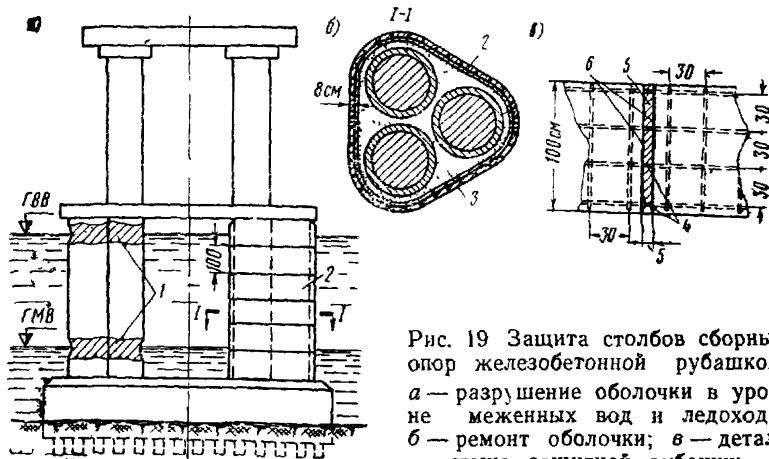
Защита столбов сборных опор железобетонной рубашкой:
